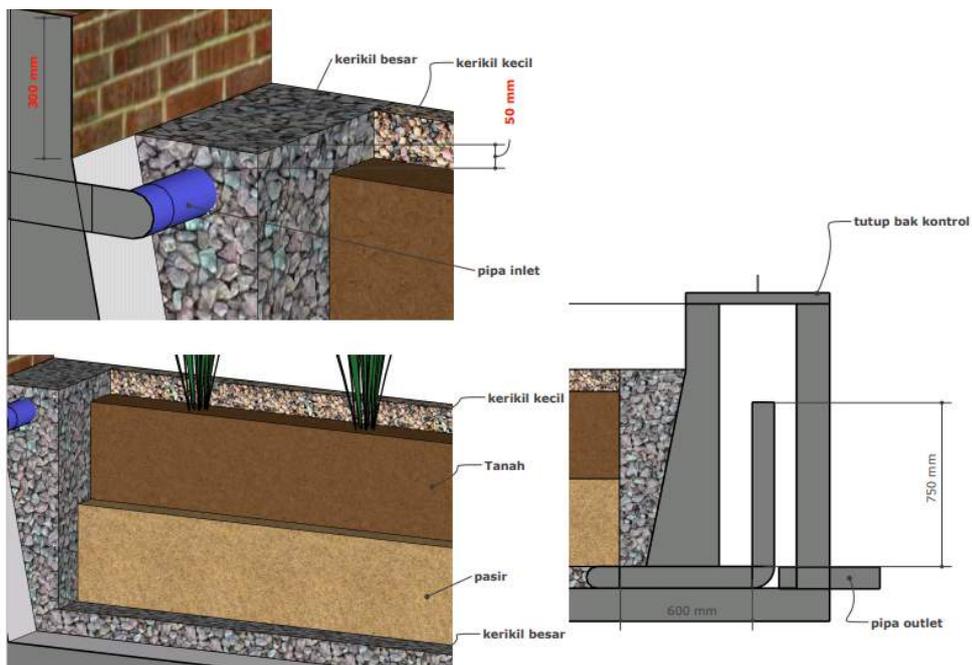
Tahap Pembangunan Waste Water Garden
